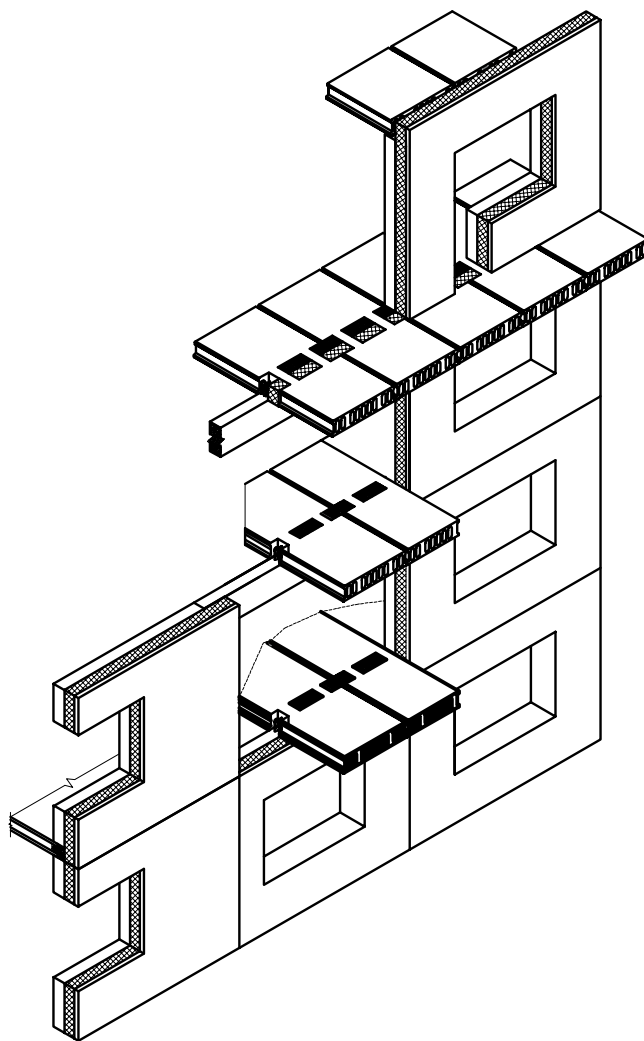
Плита пустотная с многопустотными усилителями в панельном здании
